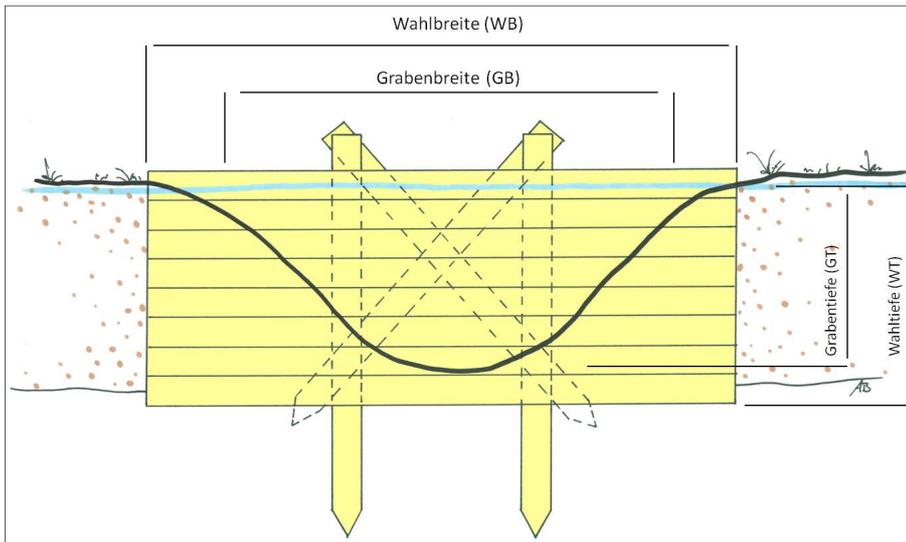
Bohlendamm (BD), Frontalansicht
